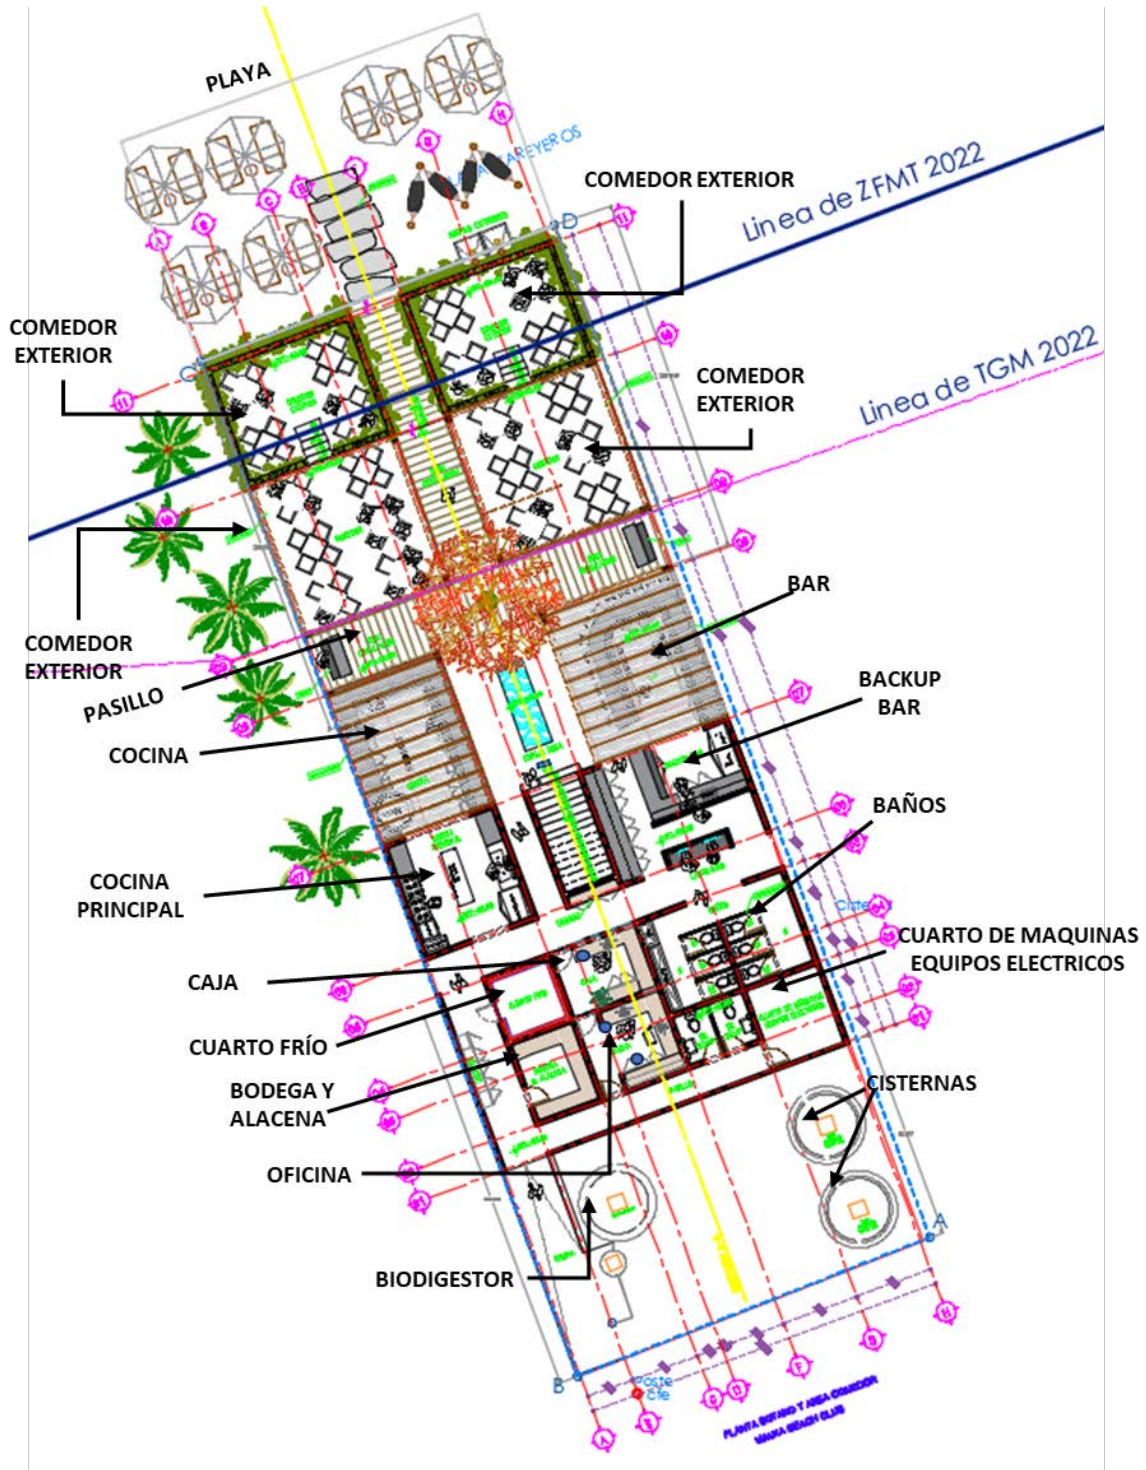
PLANTA NIVEL +01.02 INGRESO
